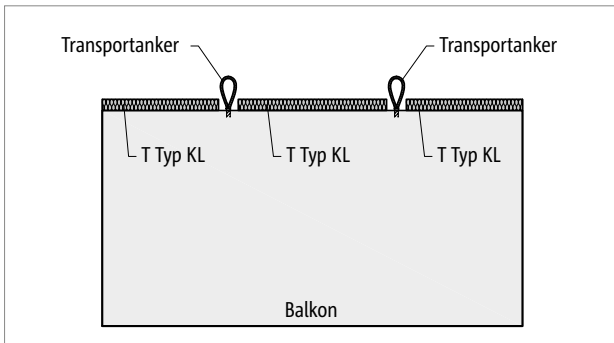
Schöck Isokorb® T Typ KL: Elementbalkon mit Transportanker; Dämmzwischenstück T Typ ZL kann bauseitig eingelegt werden
